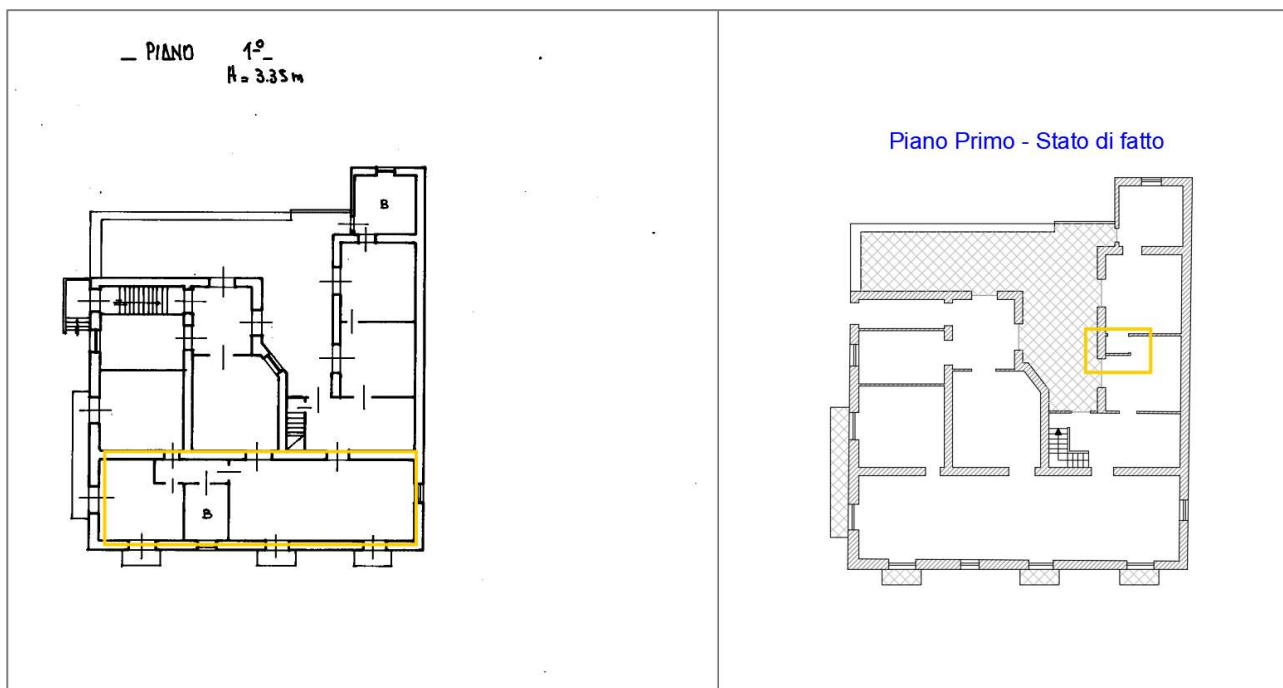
Confronto tra planimetria catastale e stato di fatto: Piano Primo
